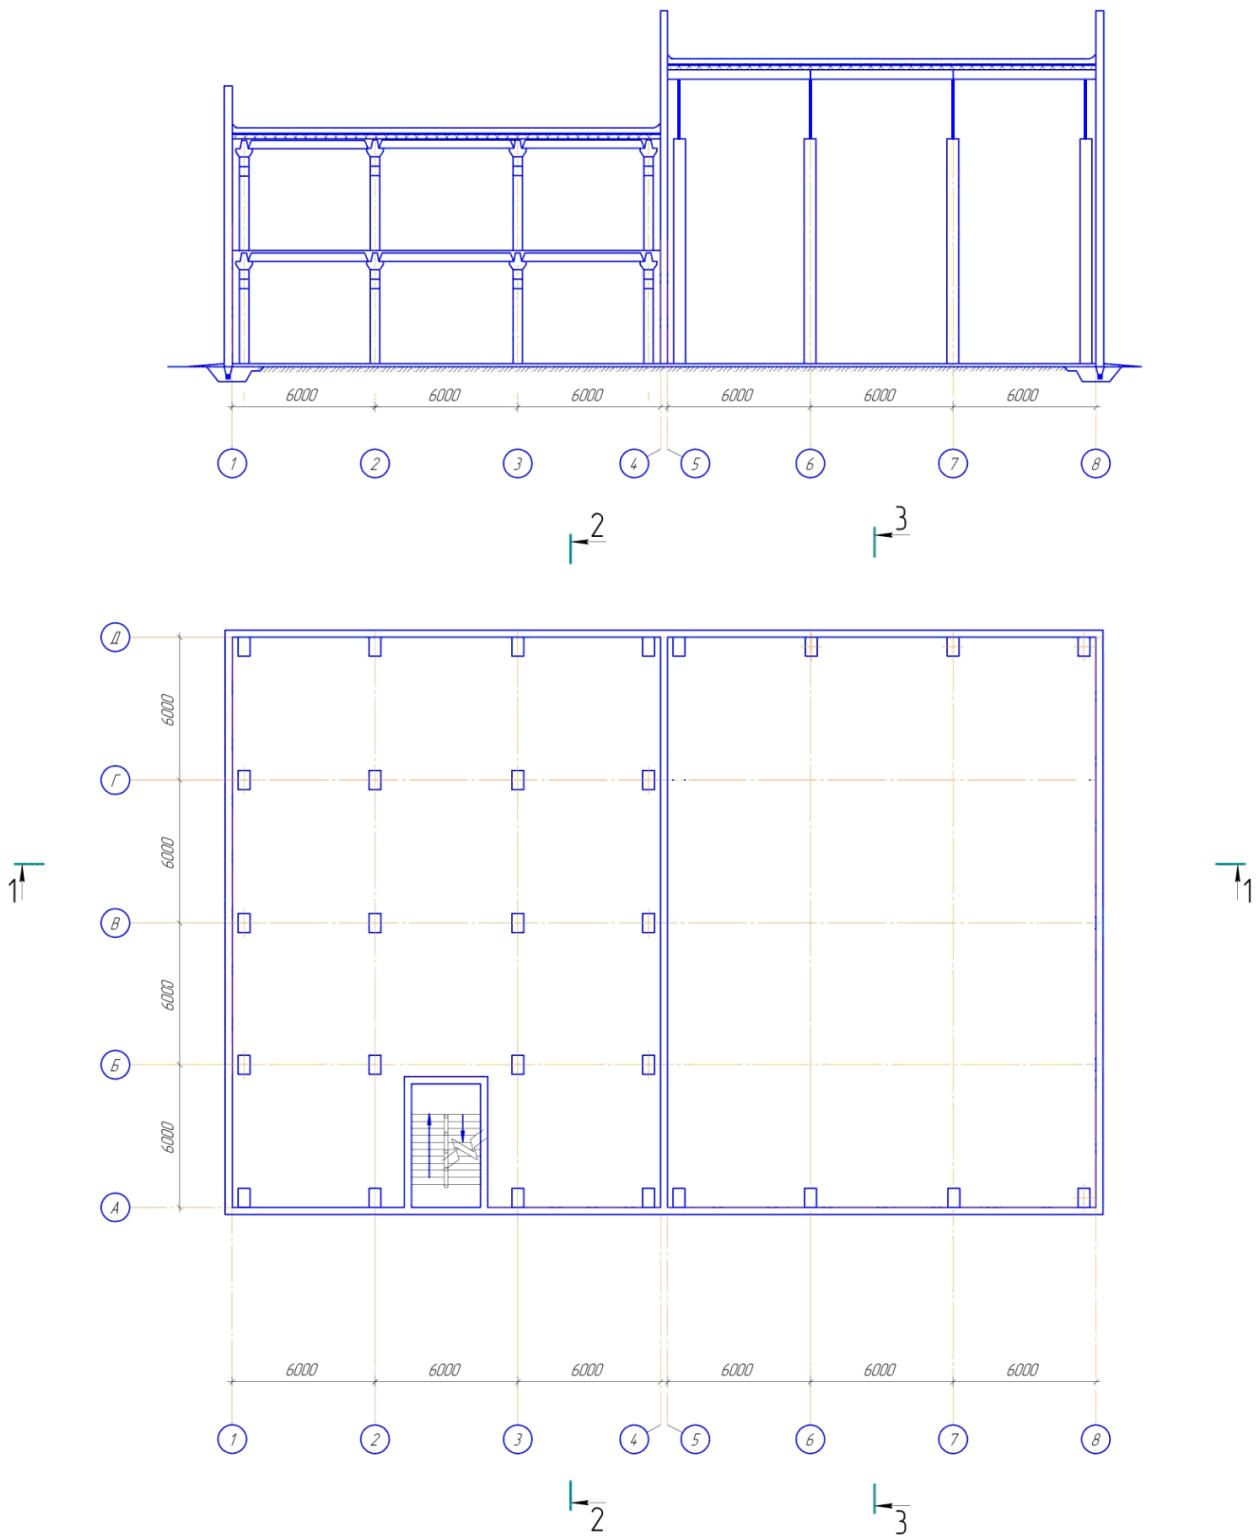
Схема плану та розрізу промислової будівлі до завдання контрольної роботи
